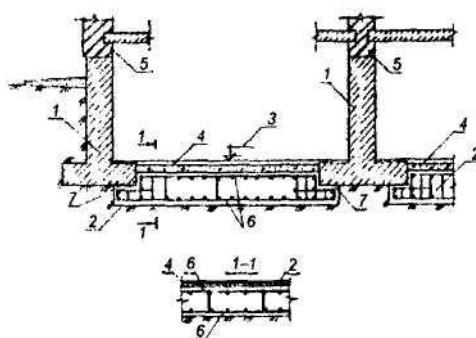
Переустройство ленточных фундаментов в плитные (устройство монолитных железобетонных плит)
